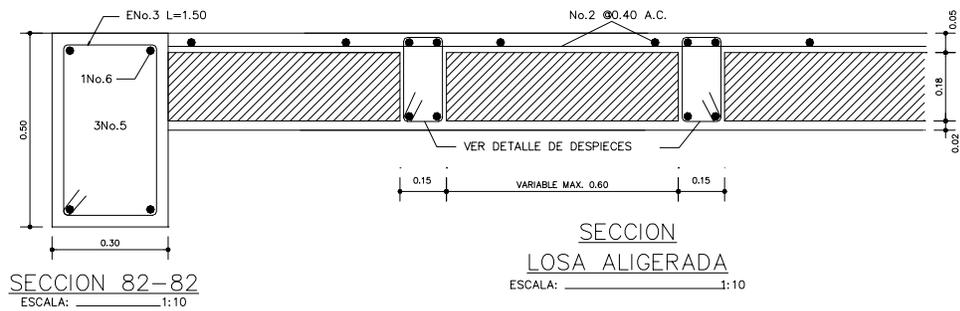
Detalle de losa aligerada con casetón y viga descolgada
